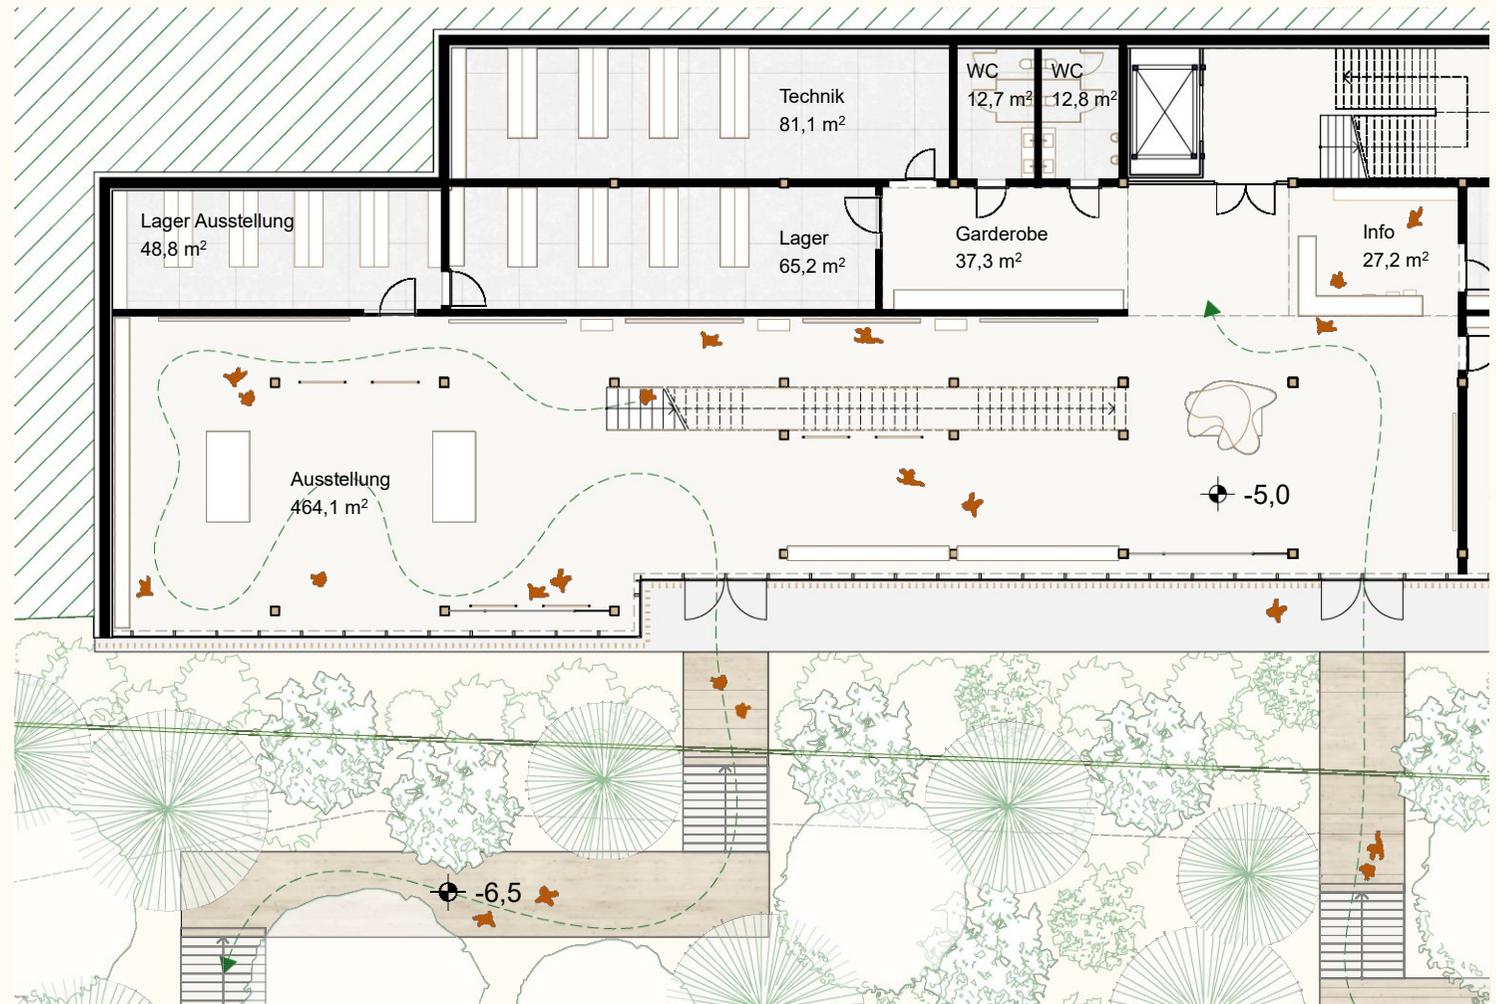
Grundriss Ausstellung UG 1:200
